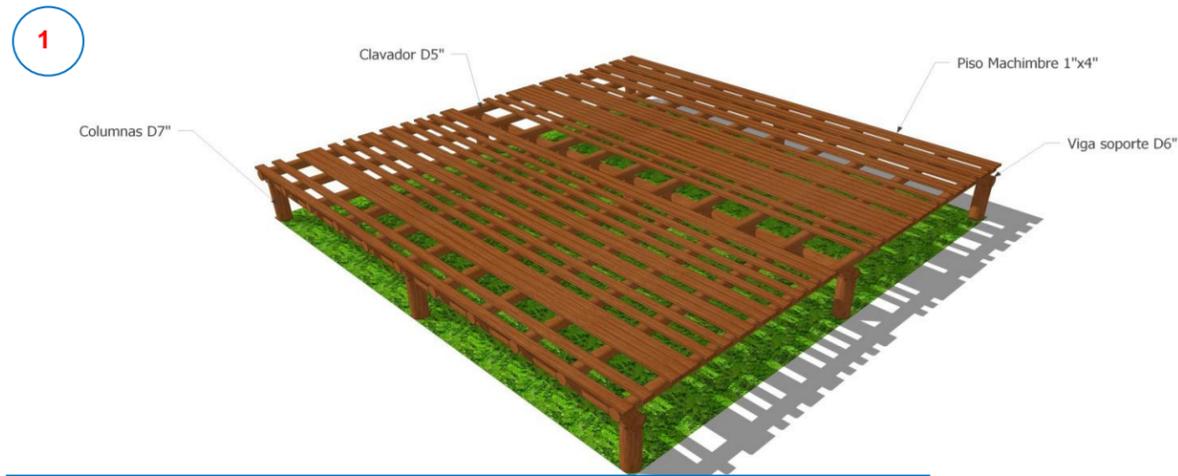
Detalle Estructural de entrepiso de madera, sistema de pilotes embazados en concreto ciclópeo, Viga perimetral y vigas clavadores que transfieren las cargas de la edificación a la fundación Fuente; Elaborado por autores
